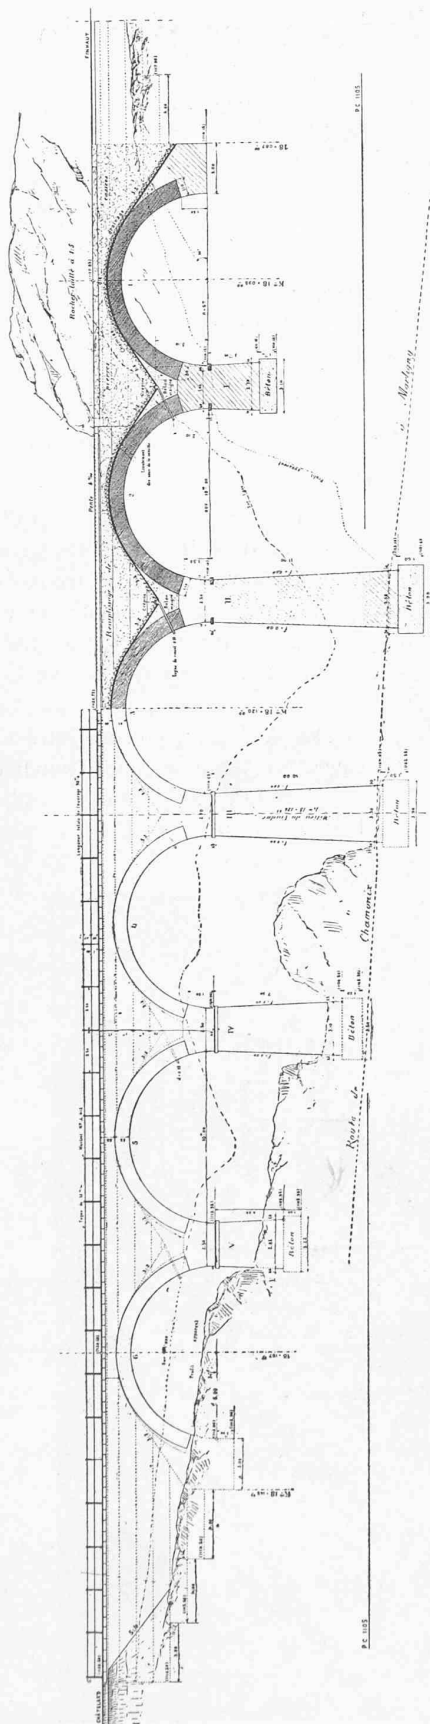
Viaduc de la Scierie, au Châtelard. — Elevation et coupe longitudinale.
